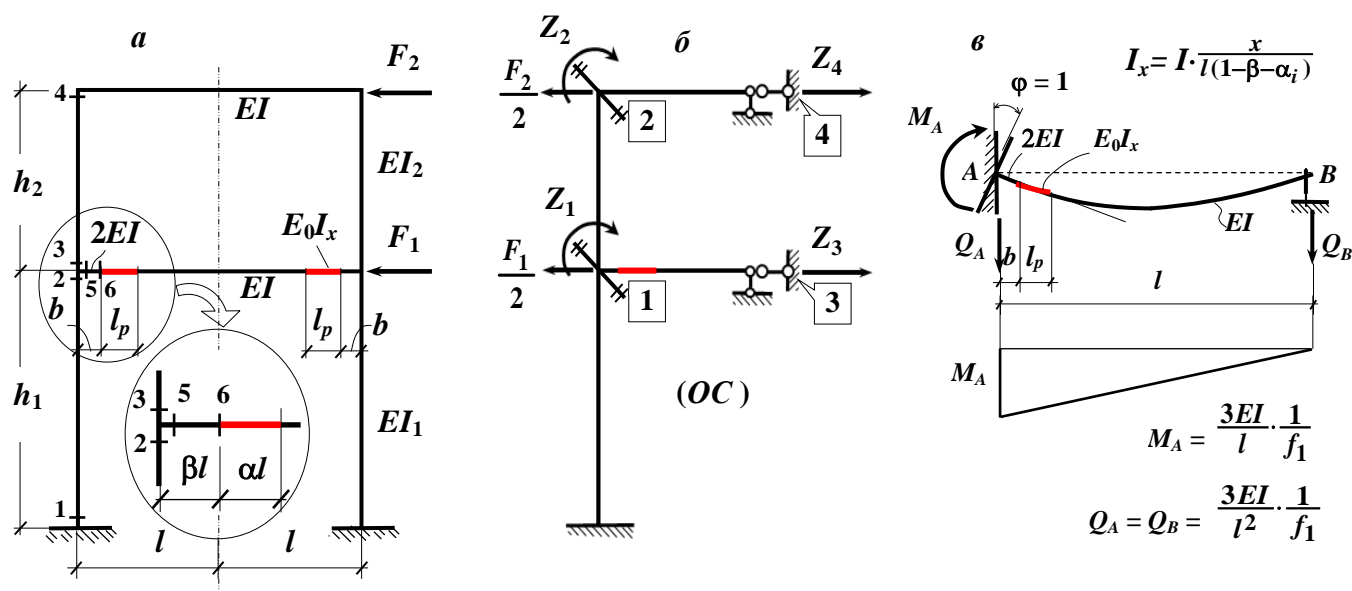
Расчетная схема 2-этажного каркаса с ПЗ в ригеле первого этажа (а); б – основная система МП с учетом симметрии каркаса; в – деформированное состояние балки с ПЗ при единичном повороте жесткого узла
